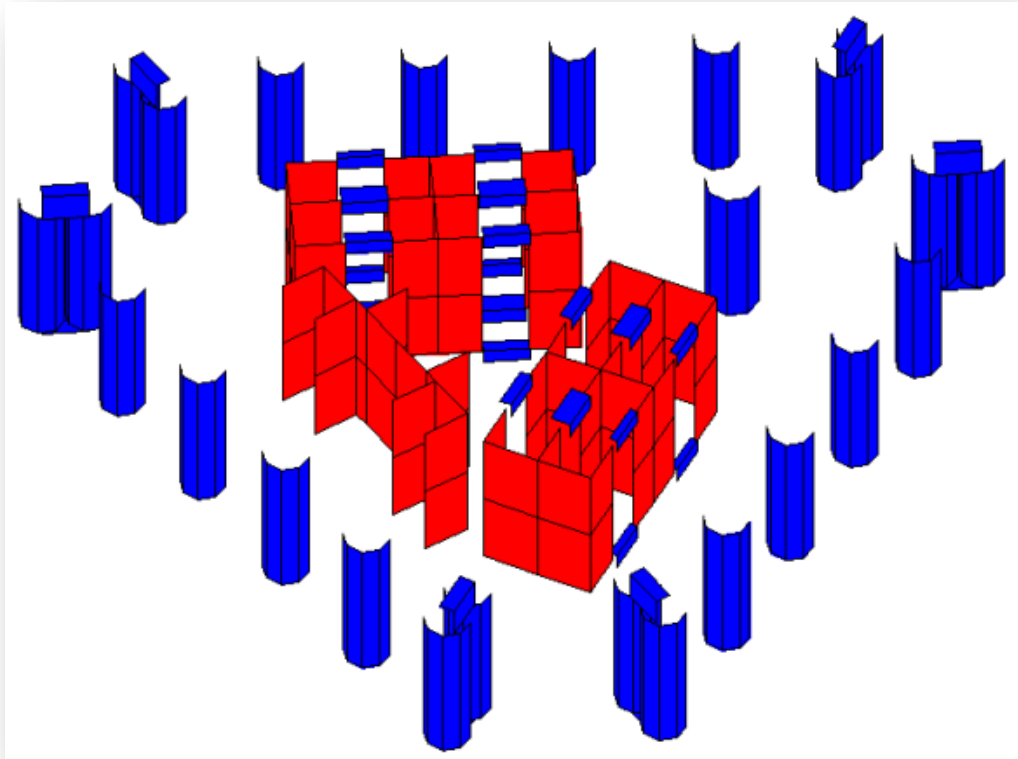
Detalle de la base del modelo 4, donde se ubican las columnas circulares.
